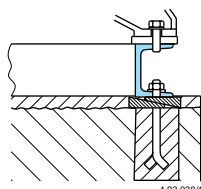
Фундамент для агрегата на опорной плите из сварного профиля.
